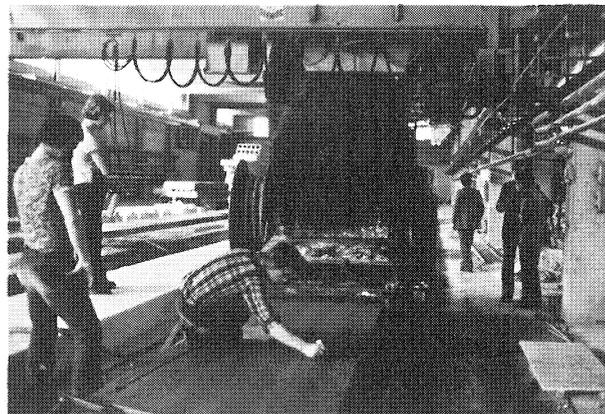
Máquina de fabricación continua de losas aligeradas pretensadas.
